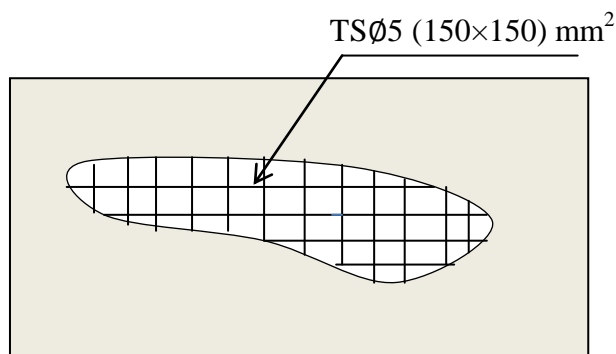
Schéma de ferrailage de la dalle de compression.
